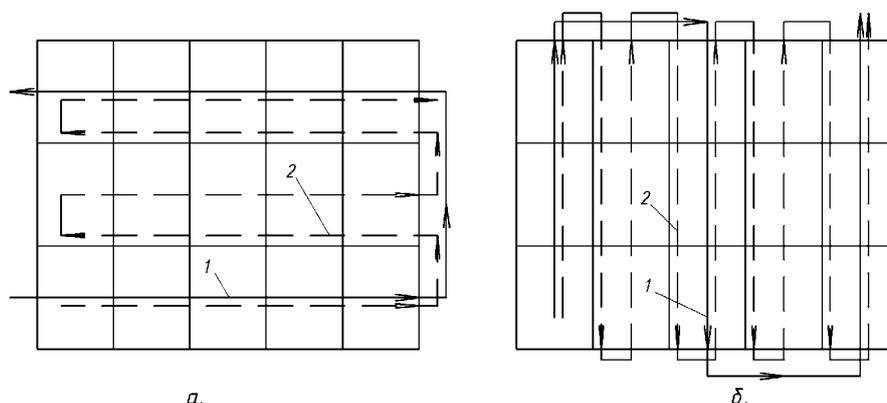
Схемы движения кранов при монтаже многопролетных промышленных зданий:
